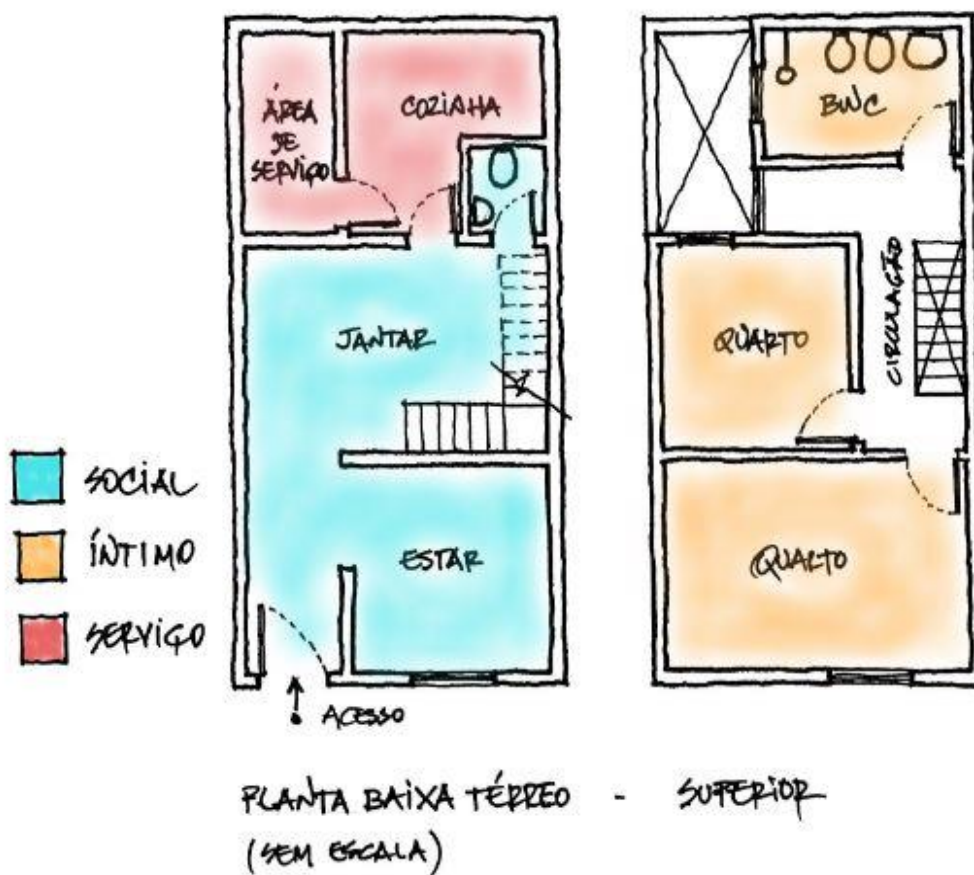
Croqui esquemático com plantas dos pavimentos térreo e superior da Vila Ercília.
